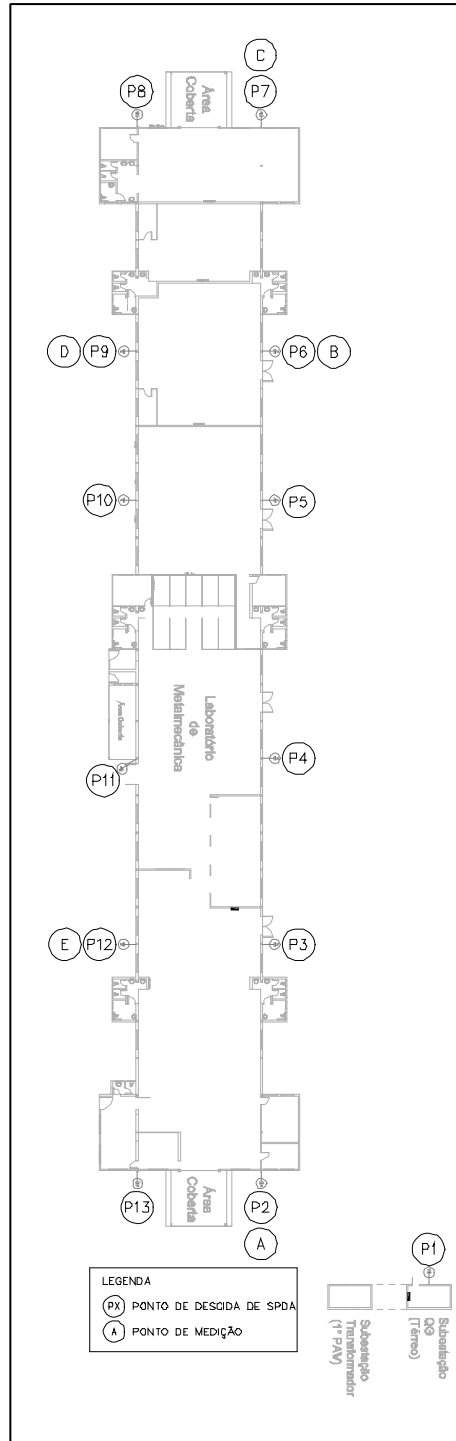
Planta com localização dos pontos de descida / medição do SPDA e Aterramento
